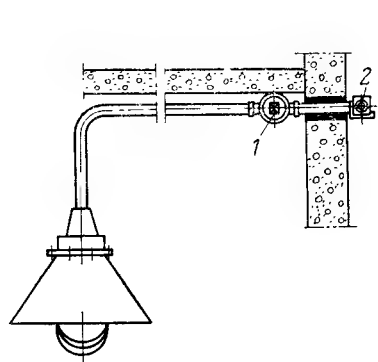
Установка фитинга ФТЗ при выходе трубопровода из взрывоопасного помещения.
